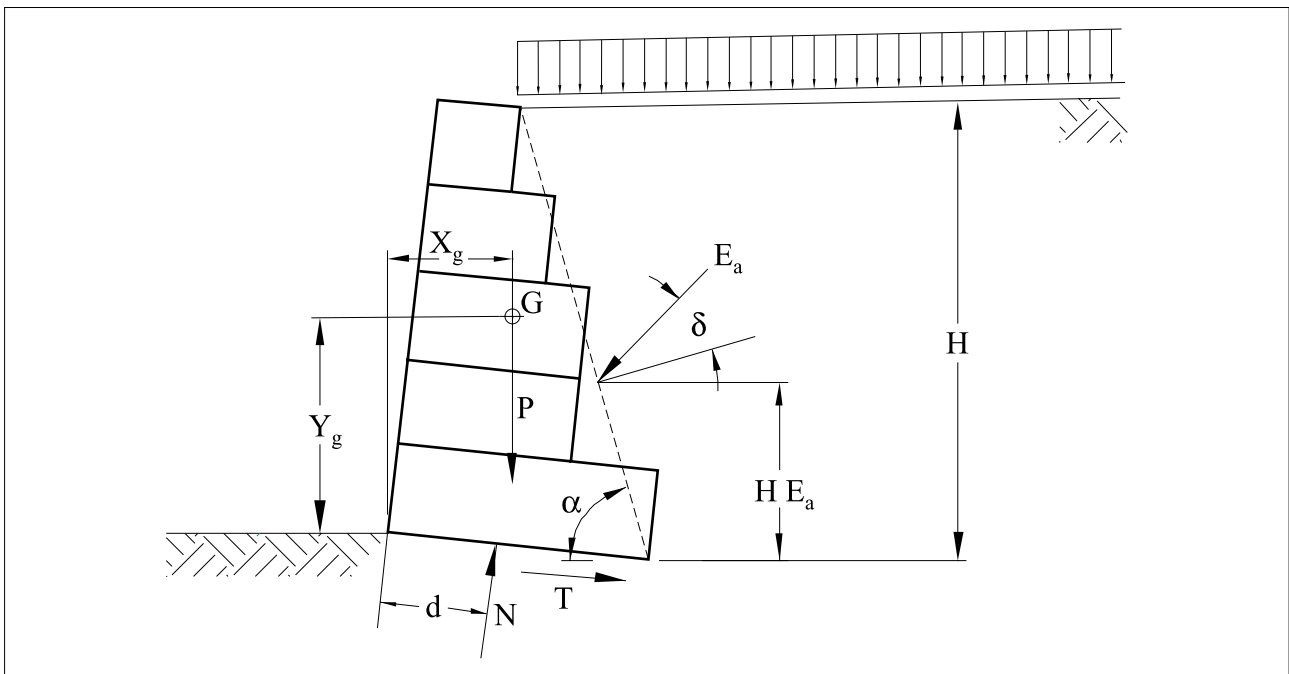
Fuerzas que actúan sobre el muro
